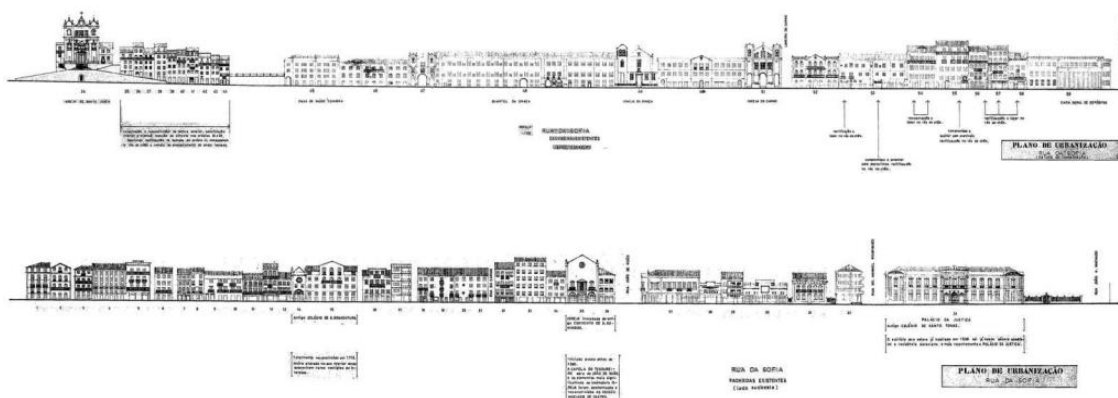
Fachadas Nascente e Poente da Rua da Sofia¹
